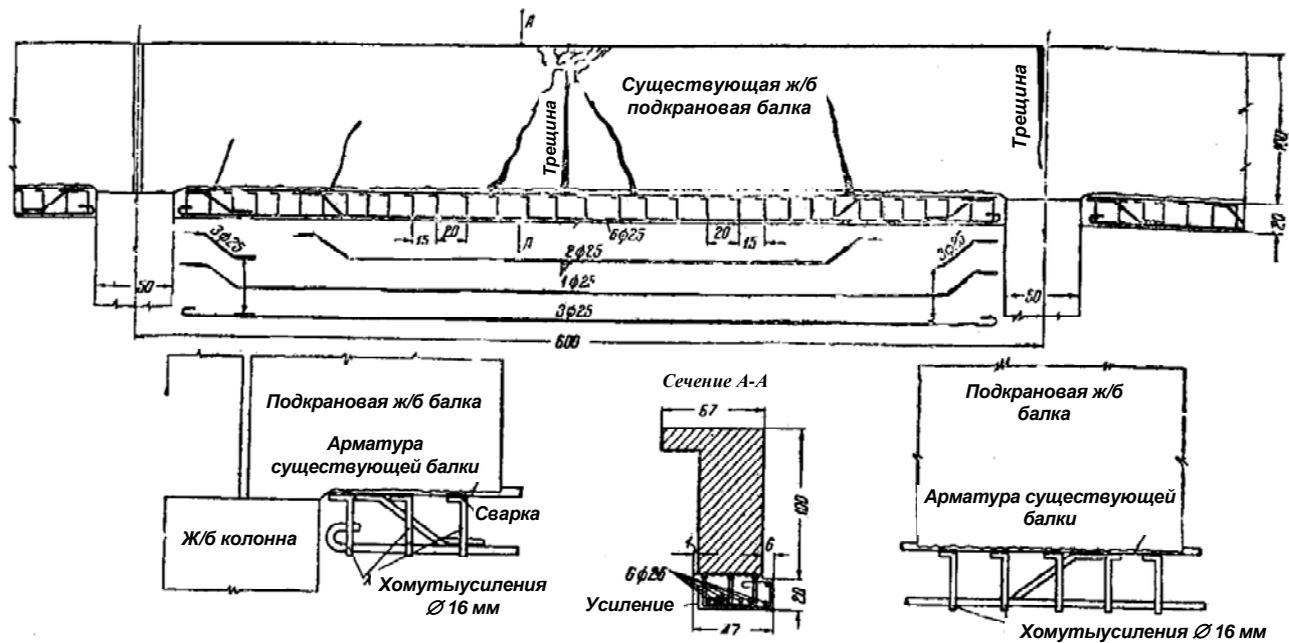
Усиление железобетонных подкрановых балок на металлургическом заводе
